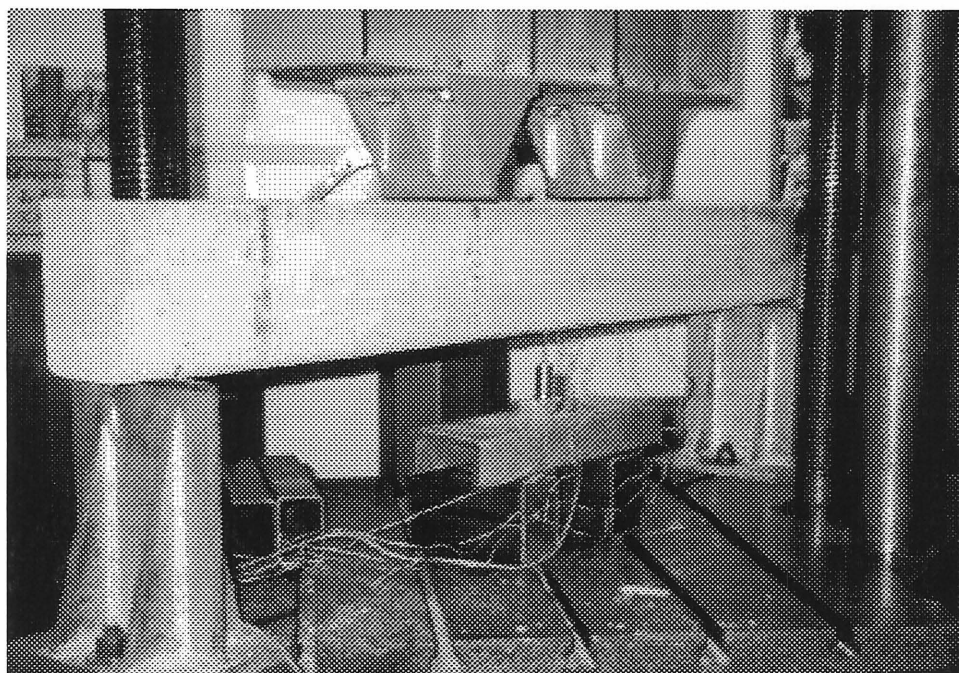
Montage d'essais sur les poutres après le mouillage-séchage
